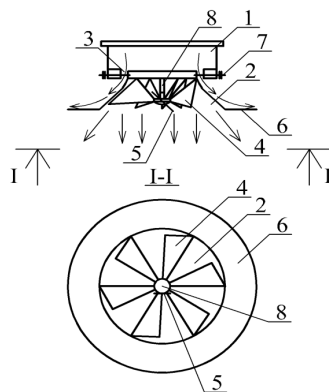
Повітророзподільник із утворенням закручених і настільних струмин: 1 – припливний патрубок; 2 – дифузор; 3 – кільцева регульована щілина; 4 – пластини; 5 – ручка керування; 6 – відбійний козирок; 7 – гвинт регулювання щілини; 8 – стержень
